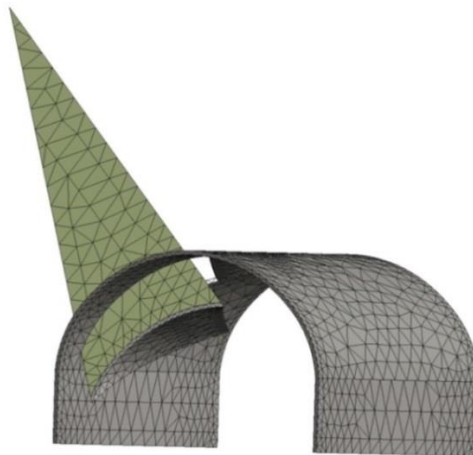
Penetración de la cuña a través de la capa de concreto lanzado, (Consultec).
